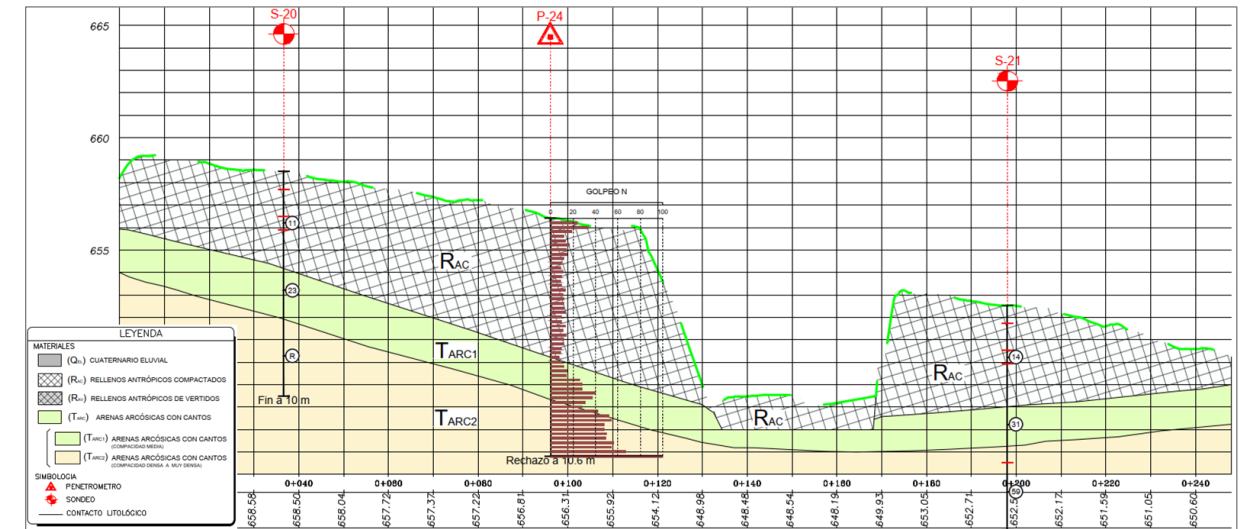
Perfil longitudinal Pantalla A1-16-MD-3
